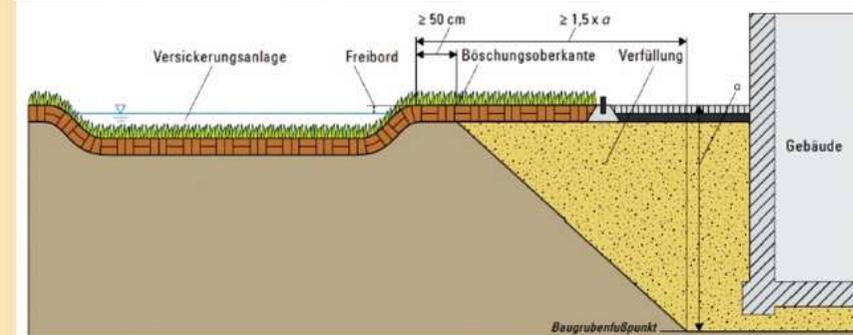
Mindestabstand dezentraler Versickerungsanlagen von Gebäuden ohne wasserdruckhaltende Abdichtung (Grafik: Bayerisches Landesamt für Umwelt, Augsburg)
